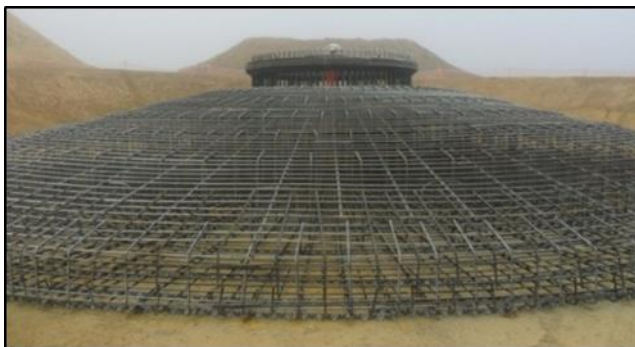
Ferrailage (Source : document interne à l'entreprise)
